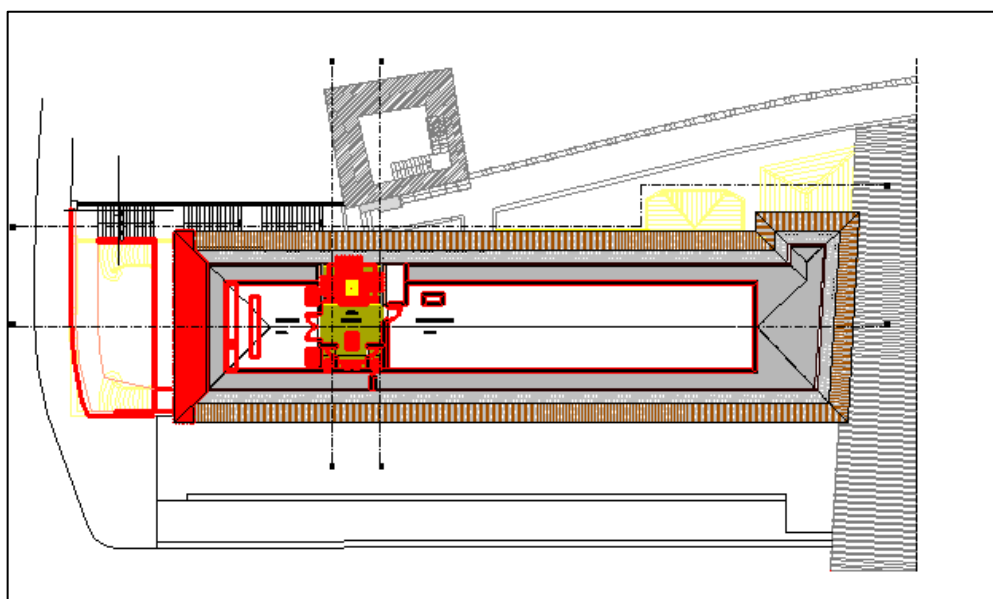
Planta vão de cobertura (existente e proposto) [22]
